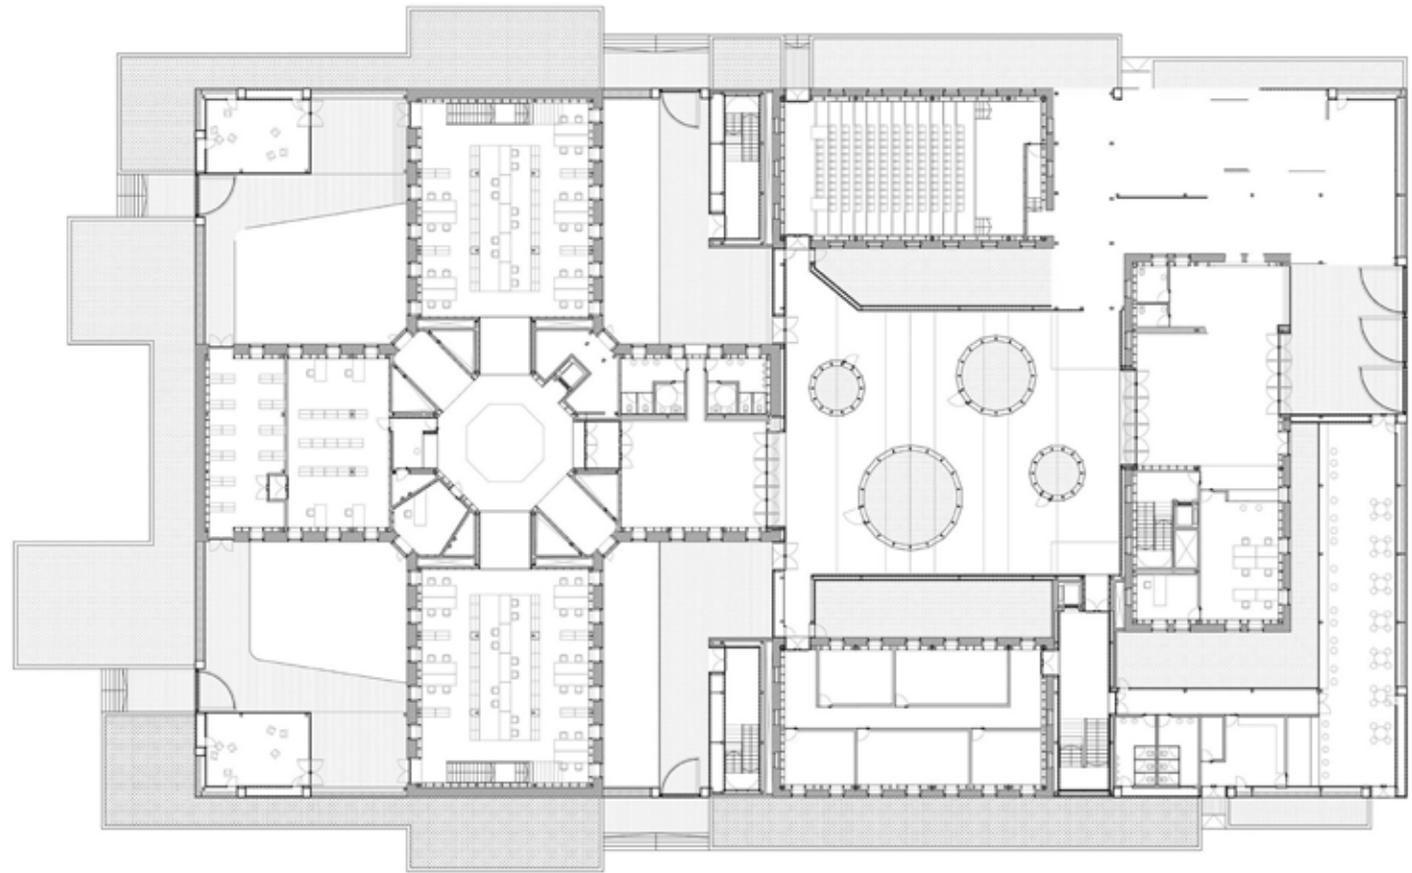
Planta de Acceso Centro Cívico-Cultural
